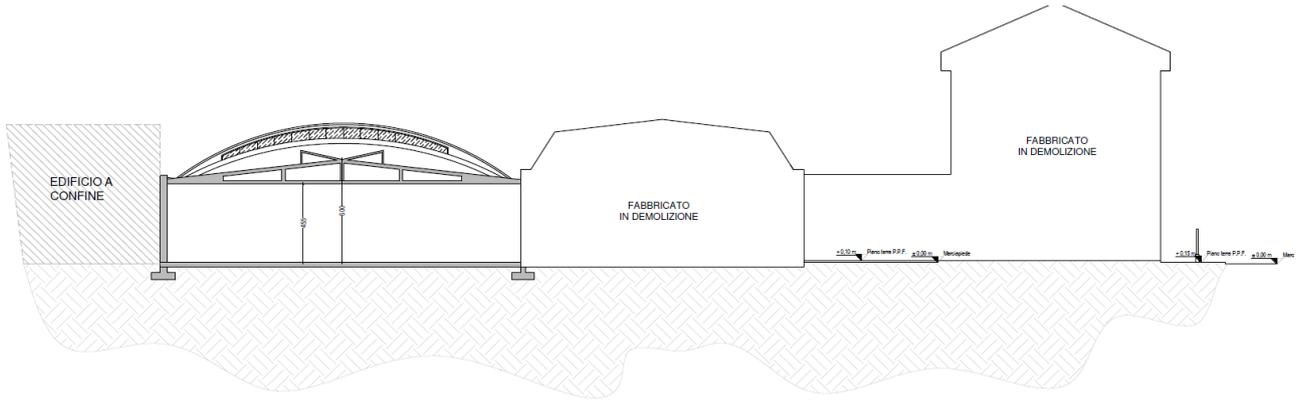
sezione b-b' stato di fatto dei fabbricati conservati
